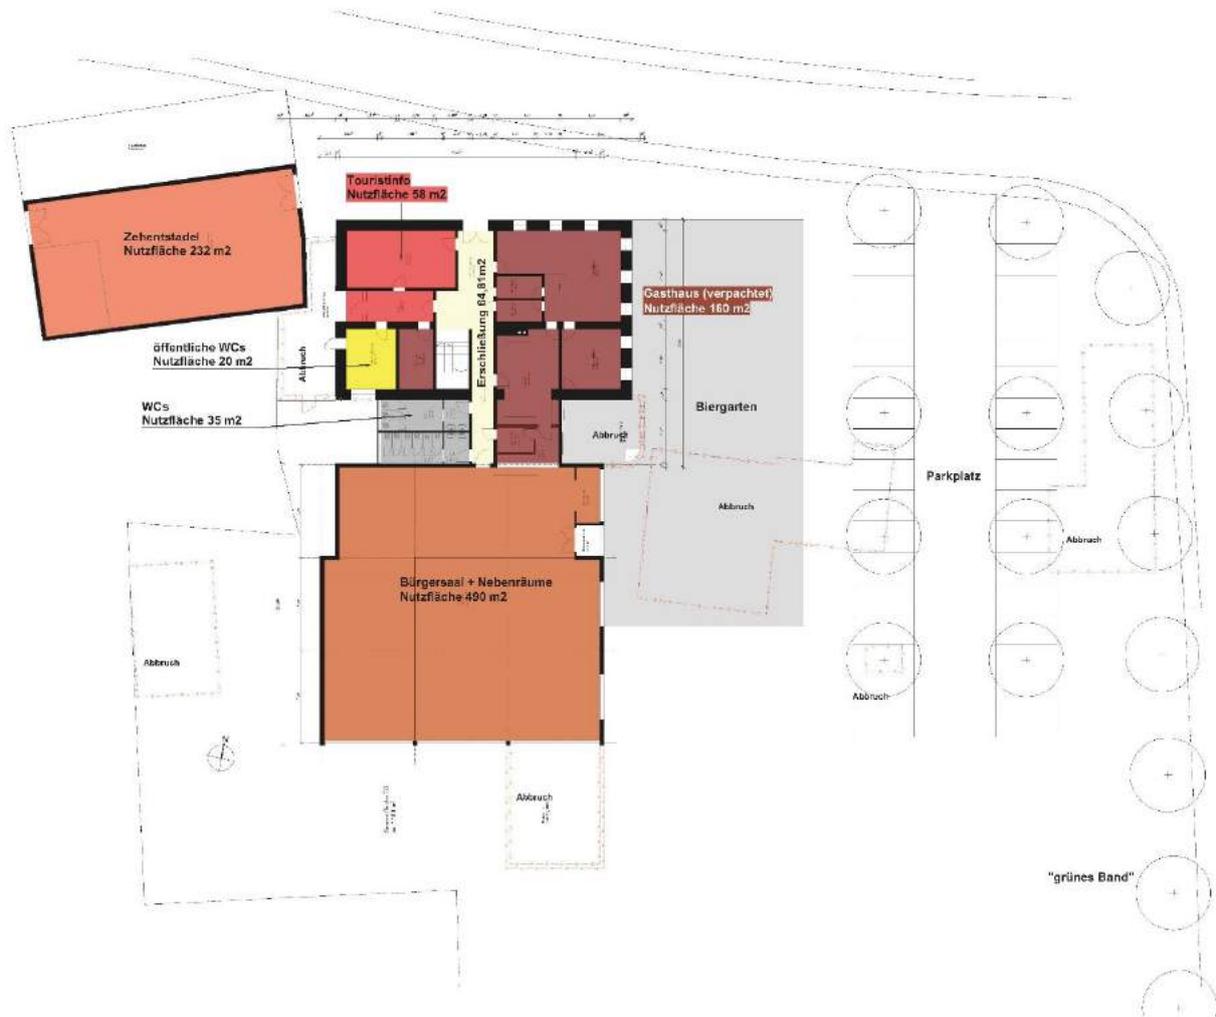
Dorfzentrum Lalling, Variante B, Erdgeschoß
